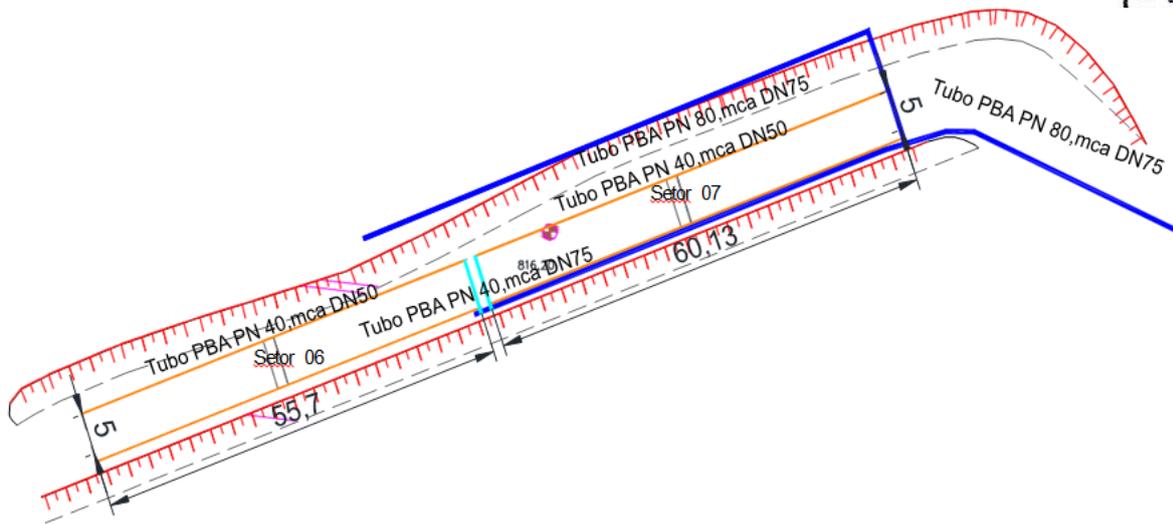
Detalhe da rede do Setor nº 6 e 7, no platô da elevação 816,20.
